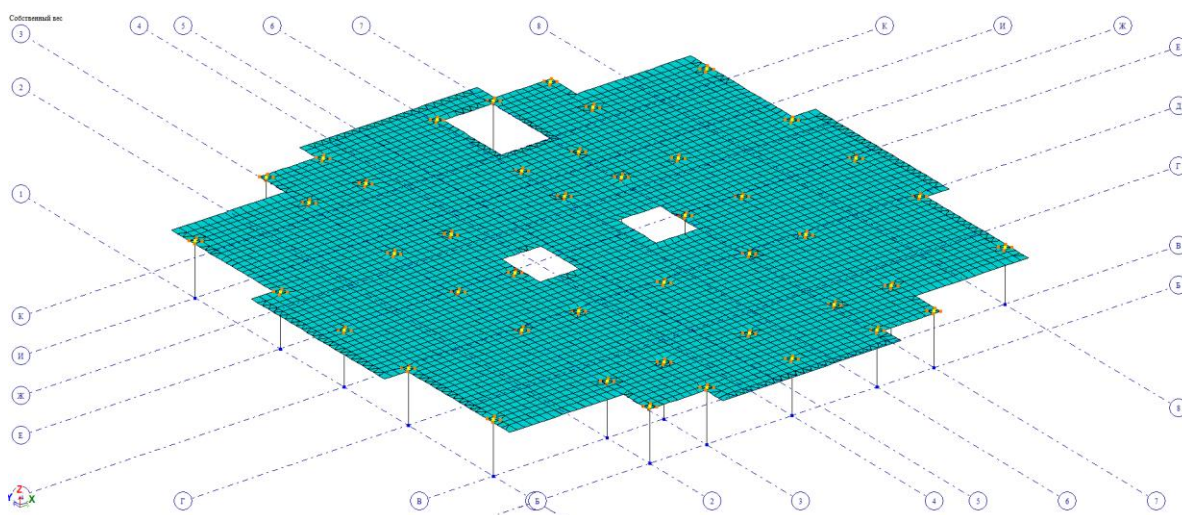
Расчетная схема плиты перекрытия типового этажа в ПК «ЛИРА-САПР»
